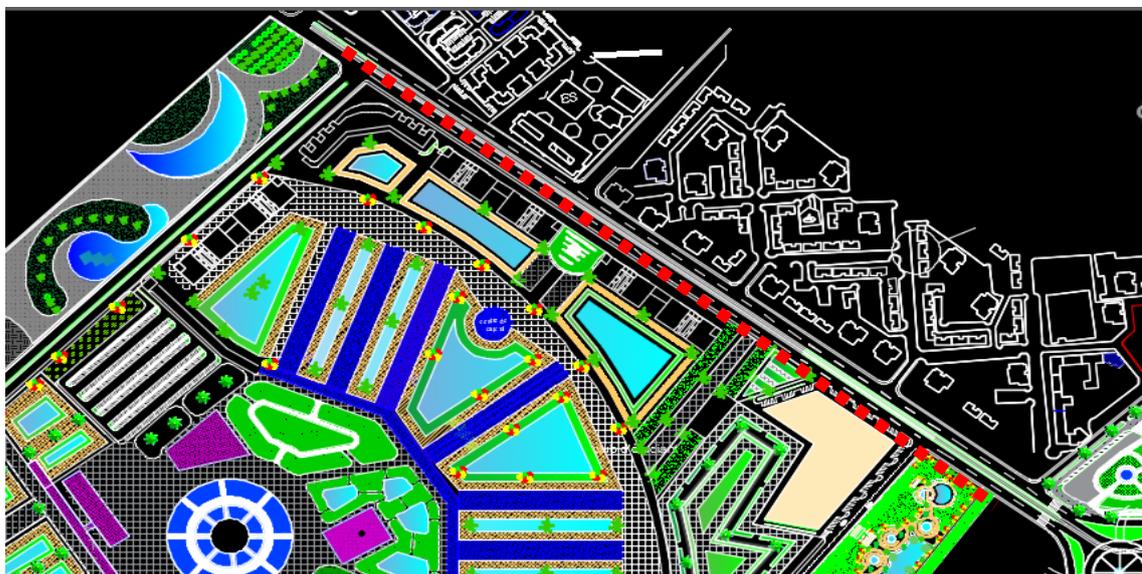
vue en plan du tramway après l'intervention /source: les auteurs.
